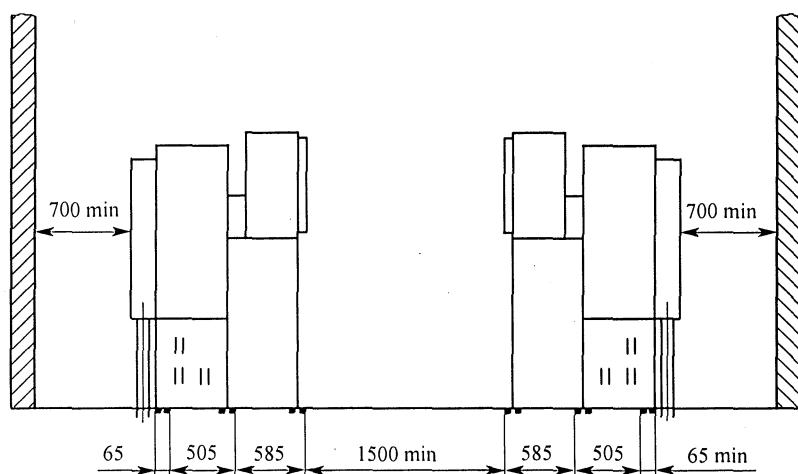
Двухрядное размещение камер К-104М с кабельными вводами снизу камеры
